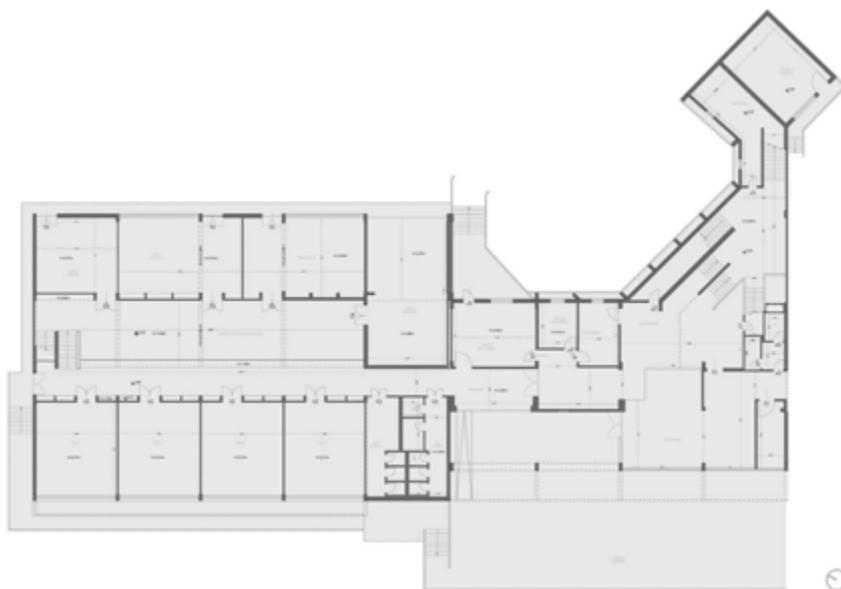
Pianta del Piano Terra allo Stato di Rilievo
